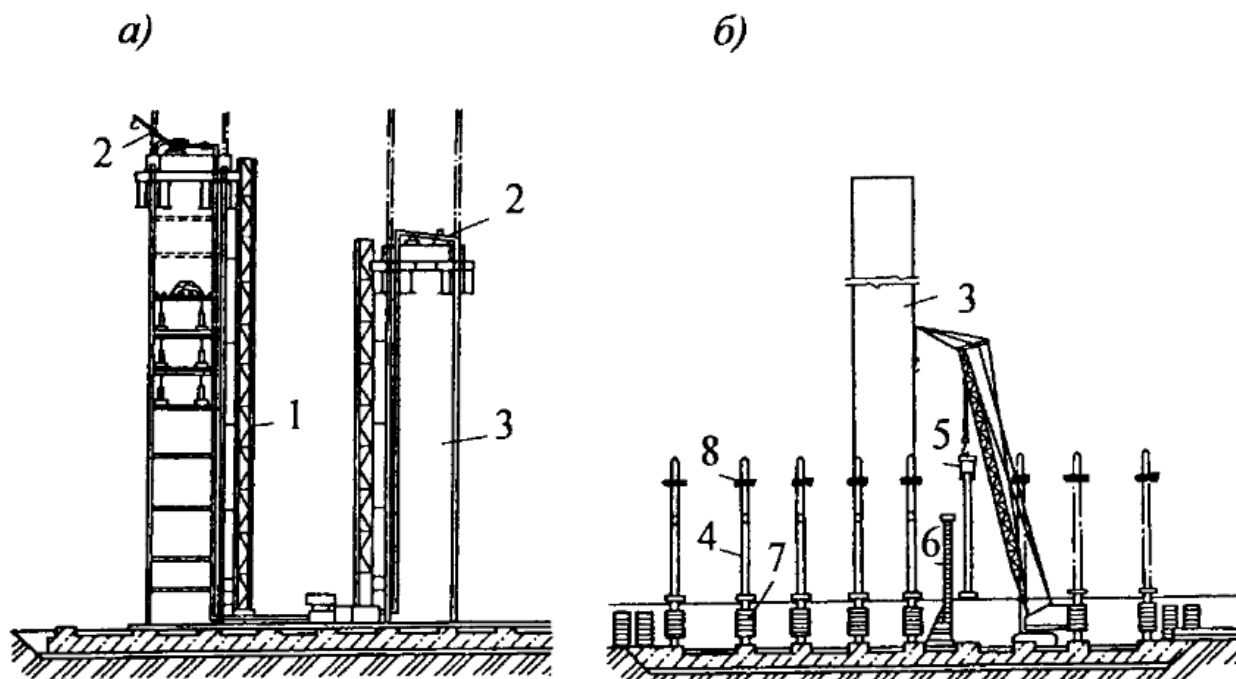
Бетонування ядра жорсткості і монтаж колон першого ярусу:
